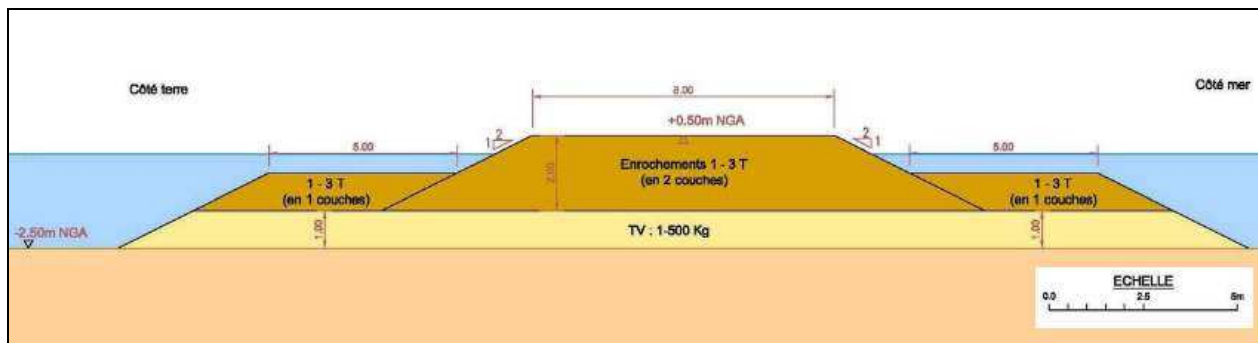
Section-type des brise-lames bas de la variante n°3 de protection de Palm Beach.
